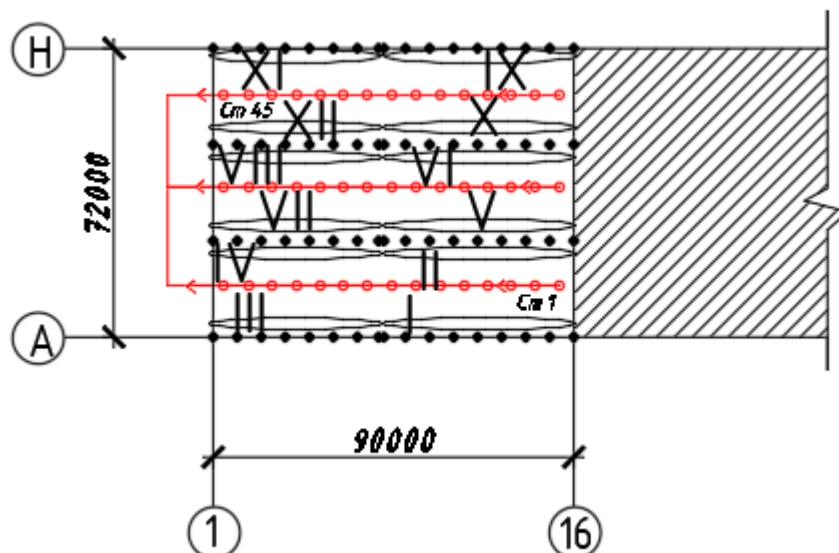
Разбивка на захваты монтажа подкрановых балок промышленного здания.
